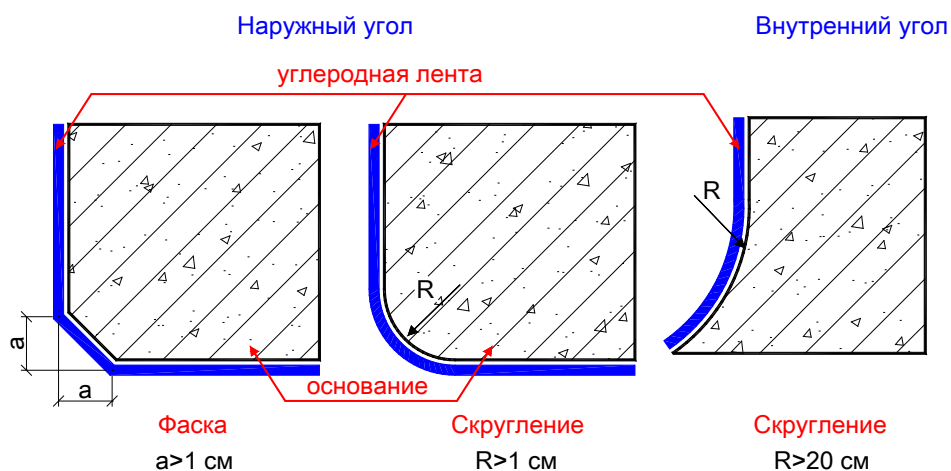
Подготовка углов конструкции перед наклейкой холстов
